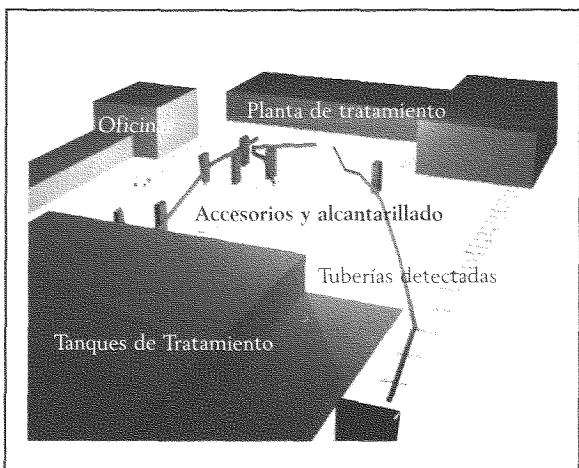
Levantamiento tridimensional de la Planta LA POLA - Ibagué
